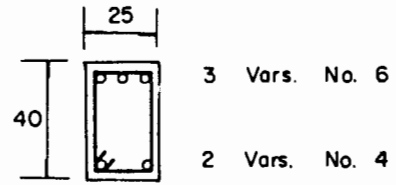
Armado de vigas usando $C=0.6$ y $Q=4$
